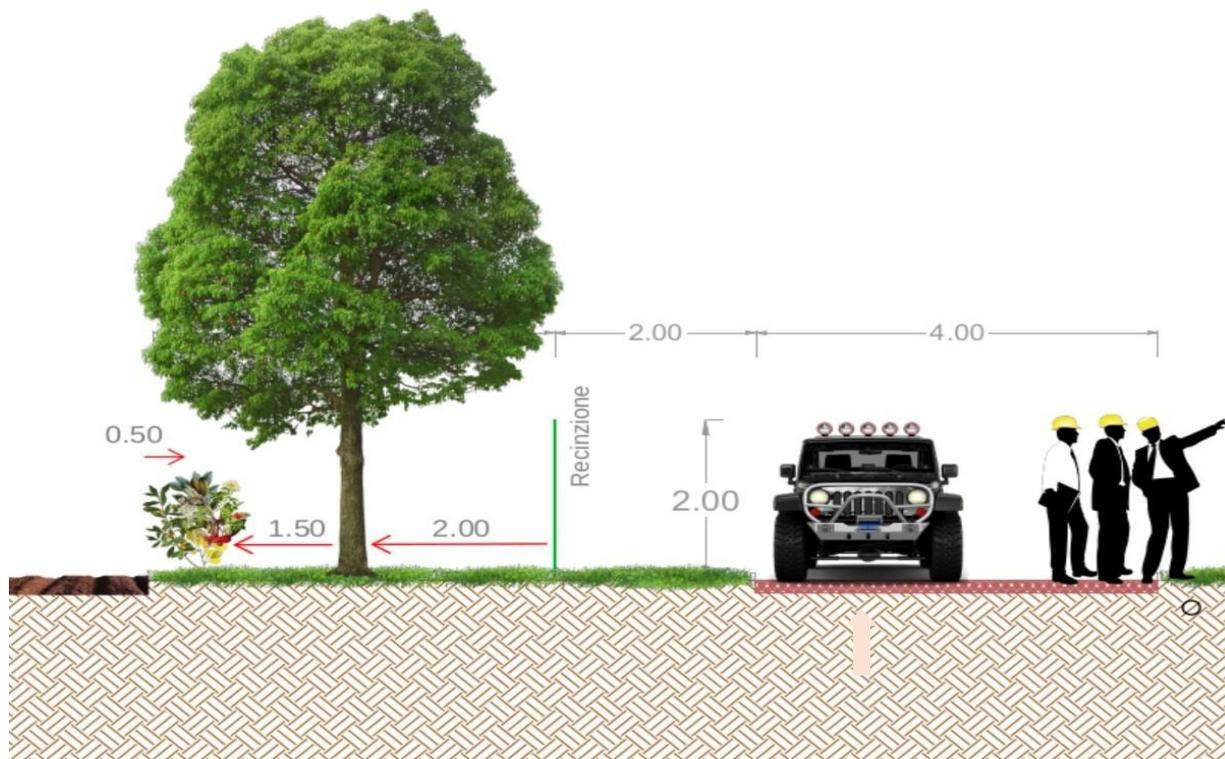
Sezione tipo d'impianto della siepe perimetrale
